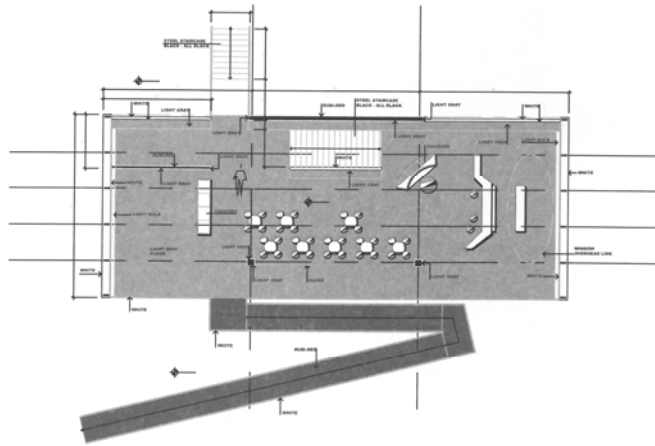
Planta do piso principal, pavilhão de Oscar Niemeyer, 2003.
